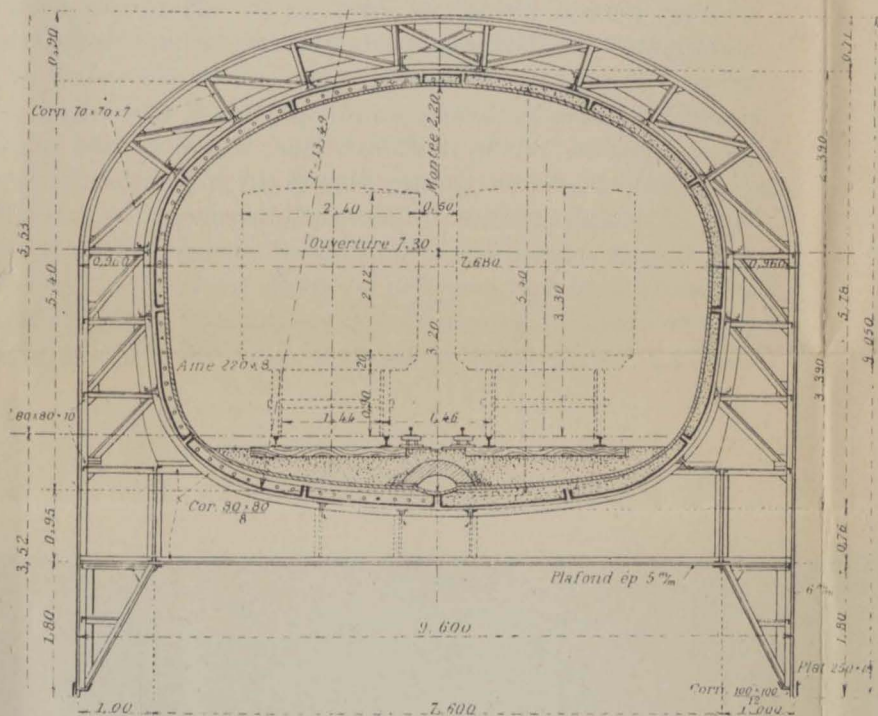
Coupe du tunnel en voie courante sous le lit de la Seine.
